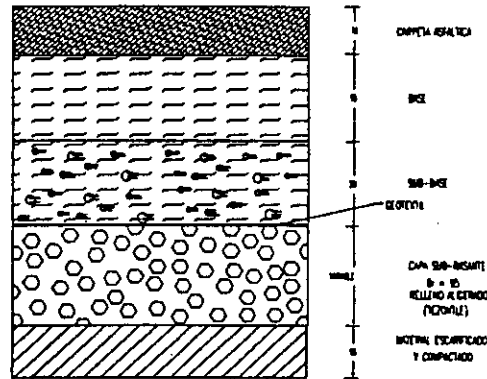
SECCIÓN DE PAVIMENTO
